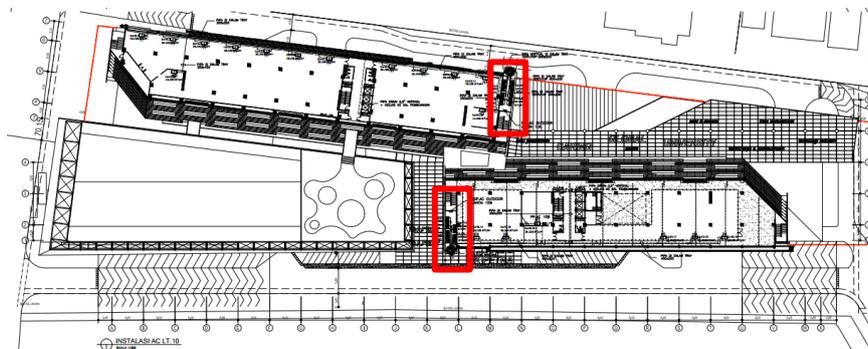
Denah posisi outdoor vrv pada lantai 6
